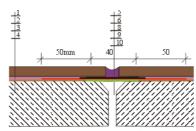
Схема гидроизоляции деформационного шва со снятыми фасками краев: 1-морозостойкая плитка, 2-клей морозостойкий для плитки, 3-покрытие Hygrostop-Эластичный, 4-железобетонная плита, 5-силикон, стойкий к солнечному излучению, 6-полоса полиэтиленовой пленки толщиной 0,3мм, 8-Hygrostop-Эластичный Армированный, 9-самоклеющаяся лента (основание под Hygrostop), 10-деформационный шов.
